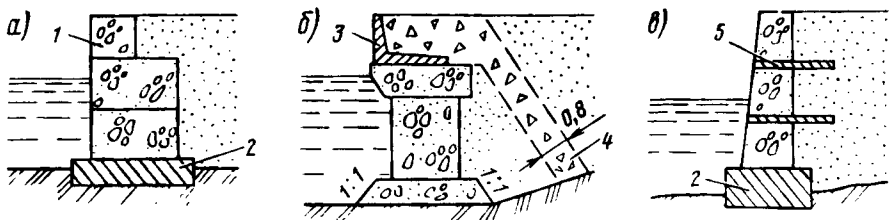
Сборные железобетонные подпорные стены из массивных блоков: 1 — блок массивной стены; 2 — фундаментный блок; 3 — угловой блок; 4 — дренажный слой щебня; 5 — железобетонная плита
